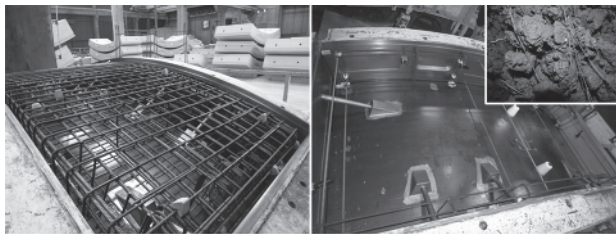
Konventionelle Tübbingbewehrung (links); Tübbing mit Stahlfasern (rechts)
